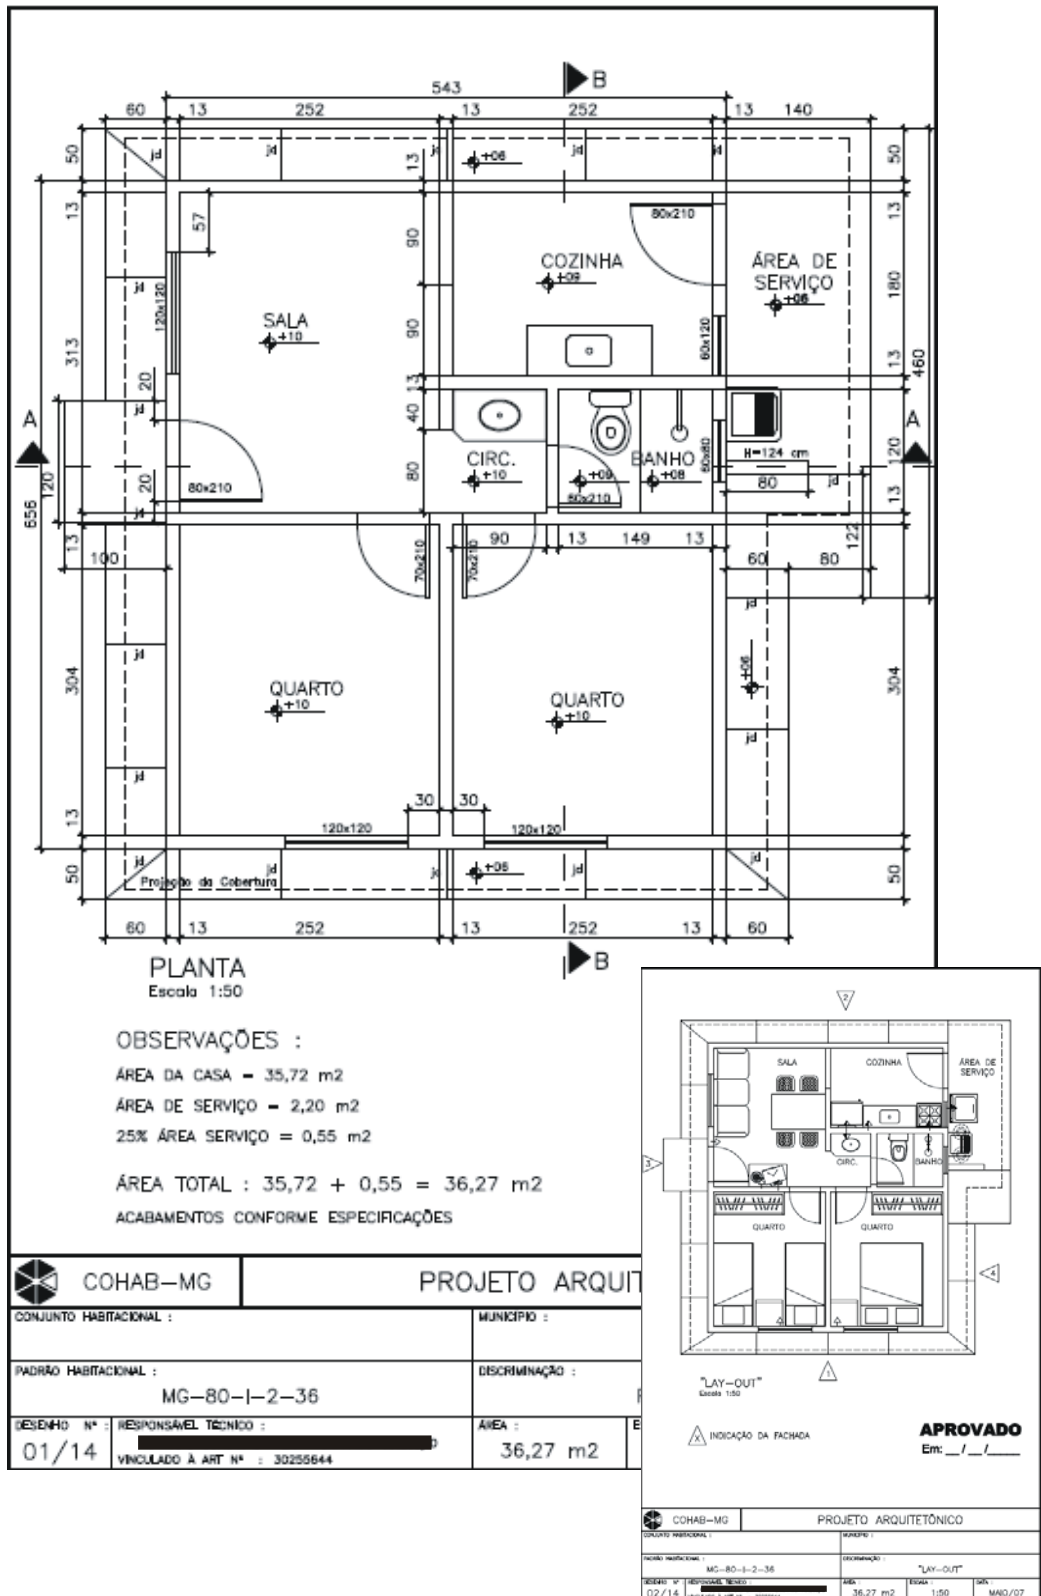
Planta baixa da casa convencional cotada- padrão COHAB-MG. Em pequena escala planta baixa da casa convencional com mobiliário- padrão COHAB- MG- Layout.
